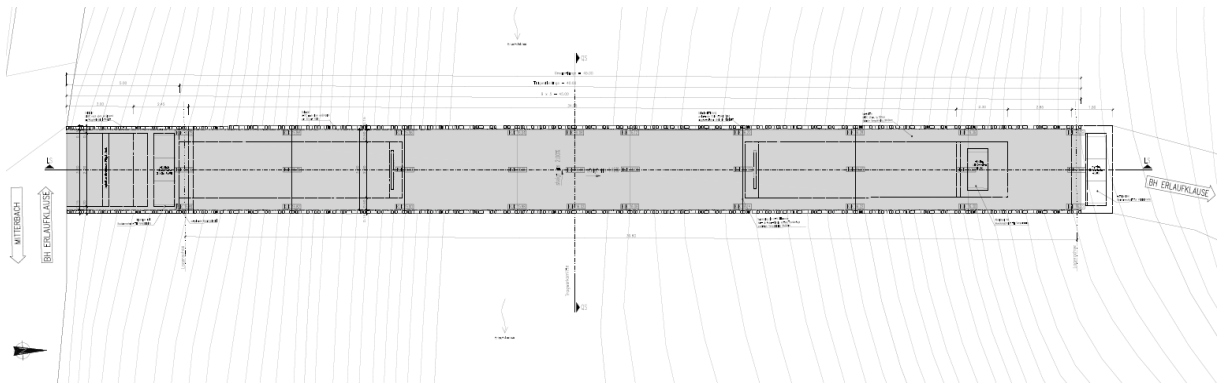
Grundriss Sprengwerkbrücke.
